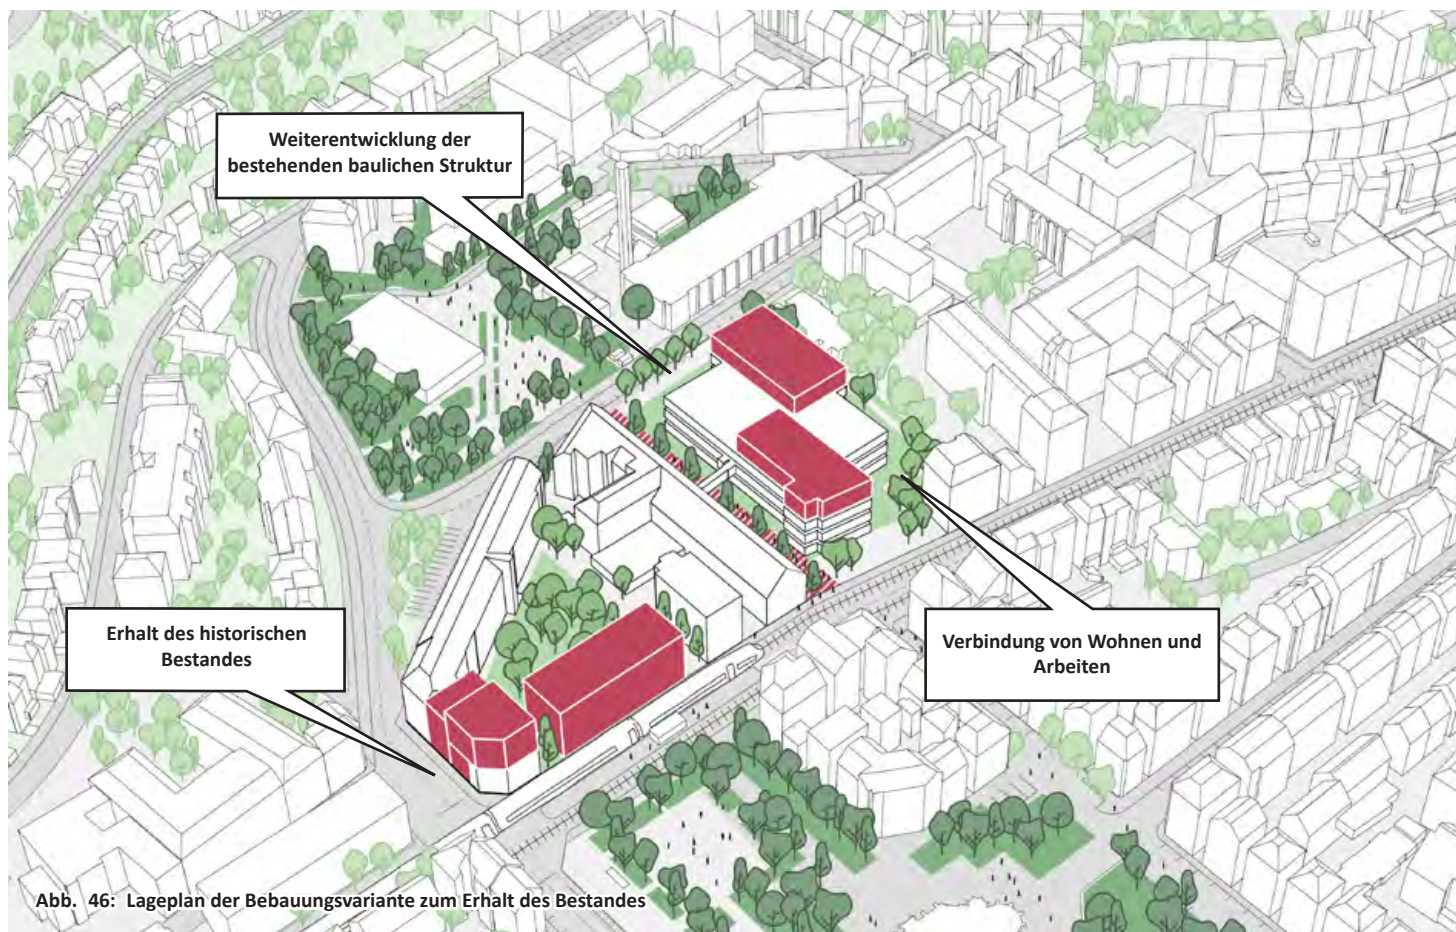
Lageplan der Bebauungsvariante zum Erhalt des Bestandes
